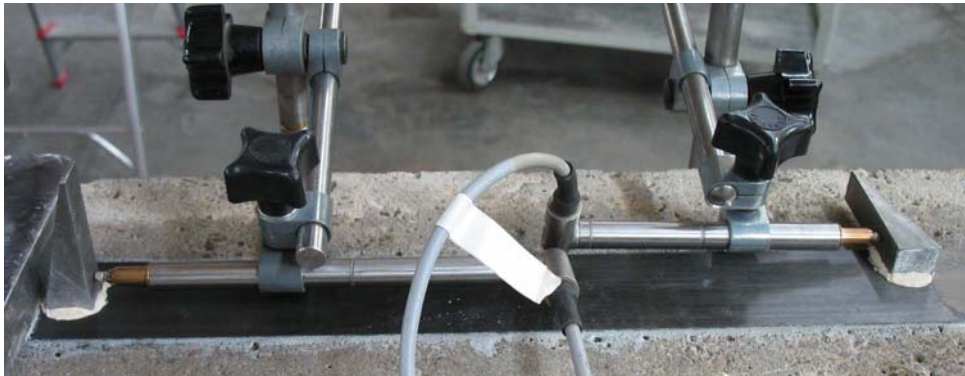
LVDT WA 10.1 e WA 20.9 Installati
